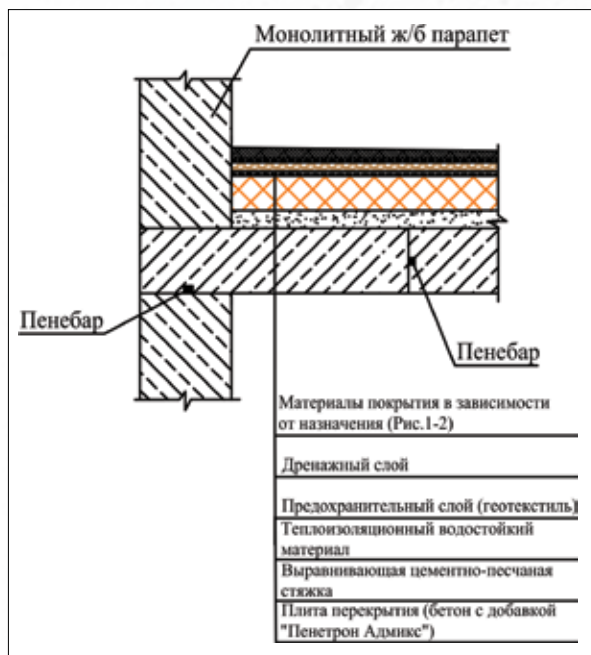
Устройство гидроизоляции монолитных перекрытий на стадии бетонирования
